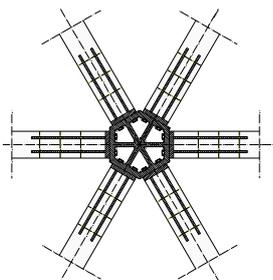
Knotendetail (Gussteil mit Schlitzblechen)
